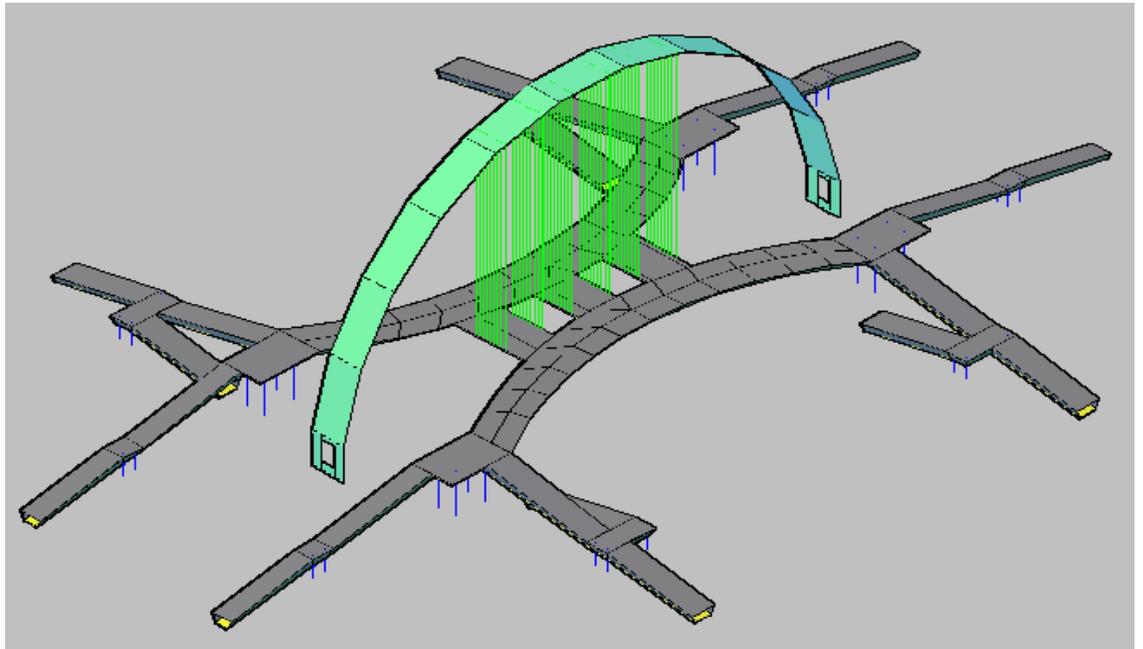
Diseño final, modelado y pre dimensionamiento estructural del puente
